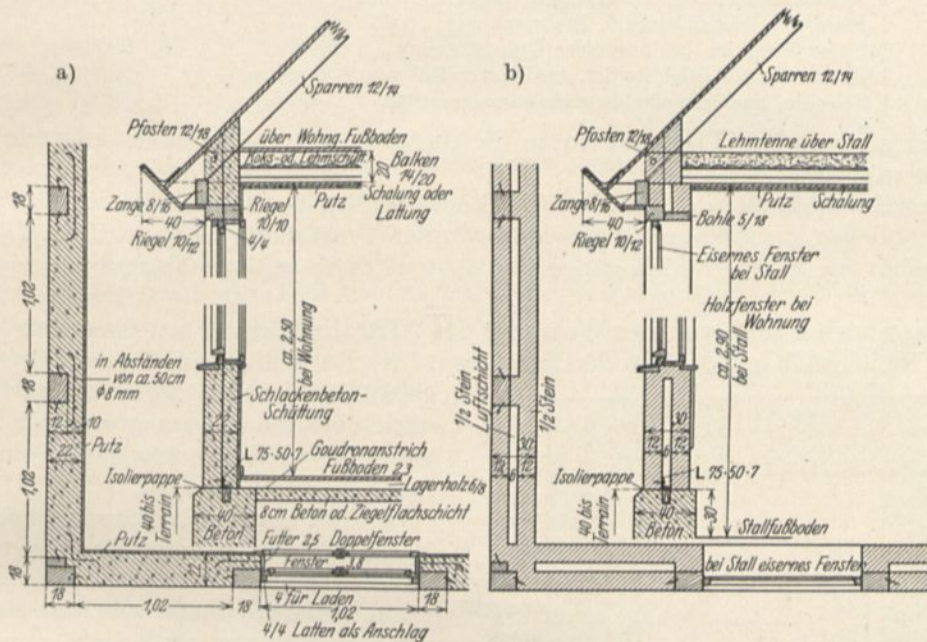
Einzelheiten zum Bauerngehöft: Wand- und Deckenausbildung nach Allg. Häuserbau-Act.-Ges. von 1872 — Adolf Sommerfeld. a) Ausführung der Wände in Schlackenbetonschüttung; b) Ausführung in 30 cm starkem Backsteinmauerwerk mit 6 cm Luftisolierschicht.
